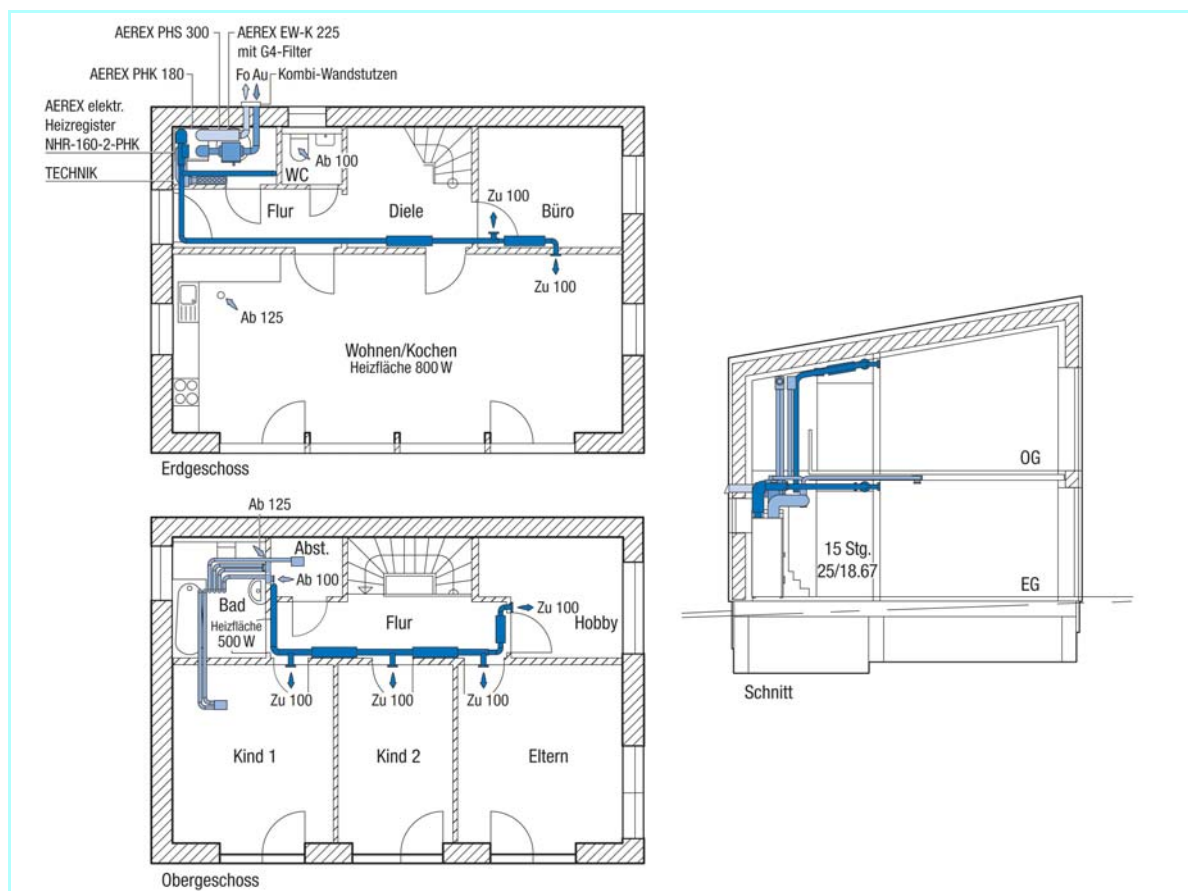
Beispiel Passivhaus-Grundriss
